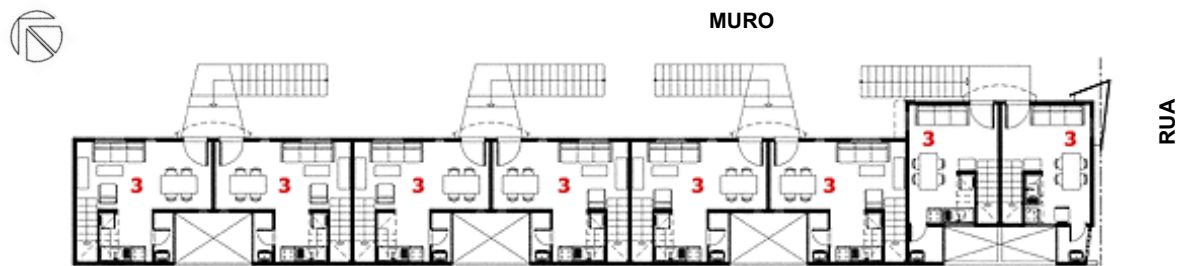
Planta tipo projeto Pedro Facchini (VB-02).
